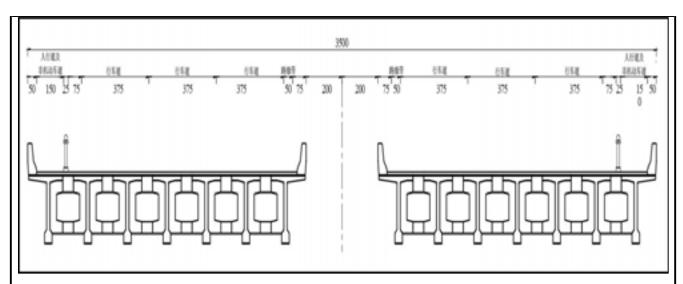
金洲大桥、金鸿大桥改造前后横断面布置示意图
